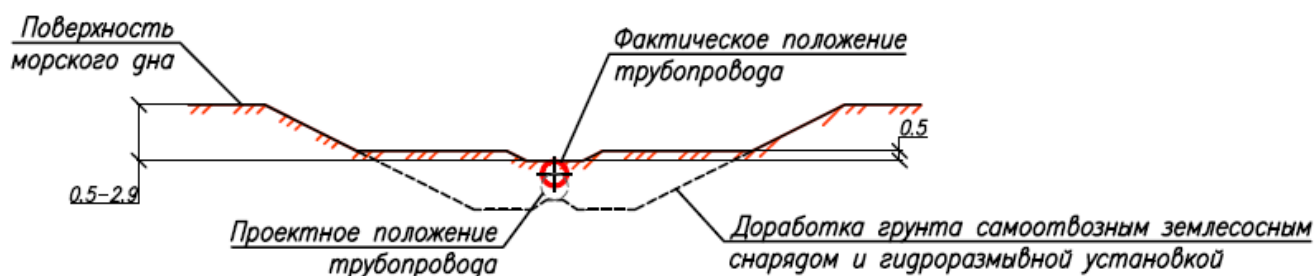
Разработка грунта самоотвозным землесосным снарядом и гидроразмывной установкой
